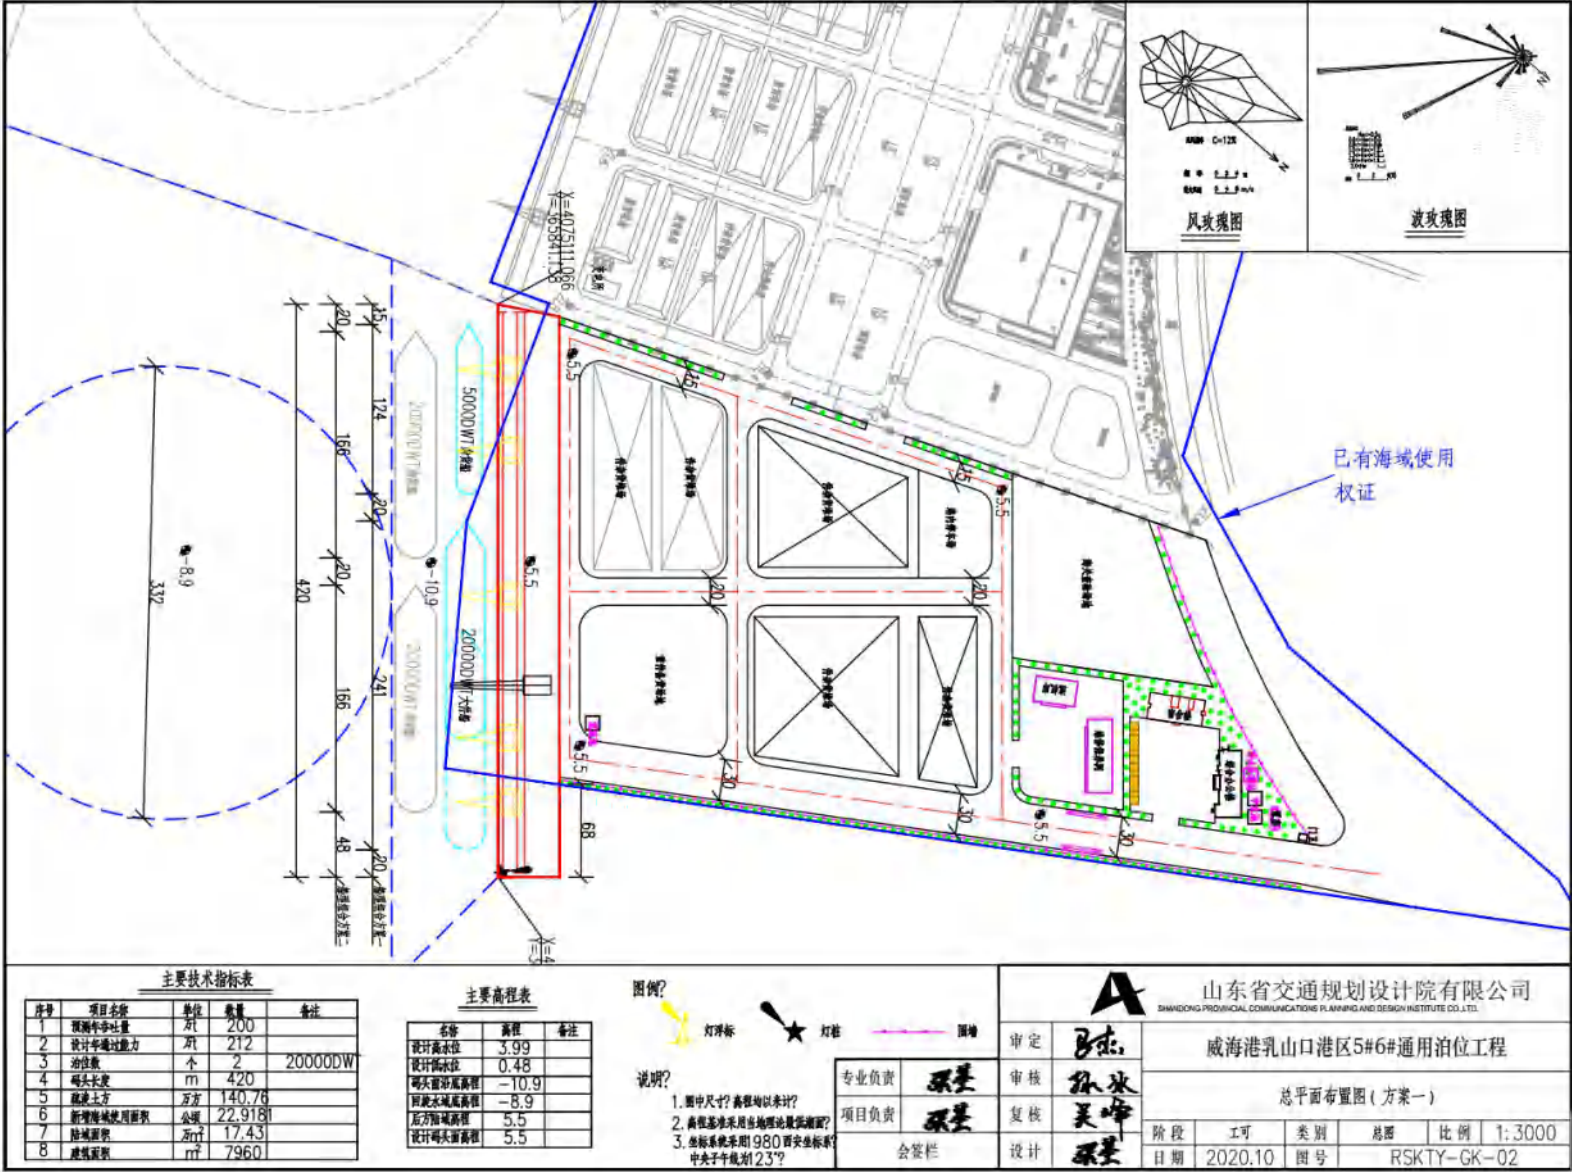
项目平面布置图 (高程基准为当地最低理论潮面)
